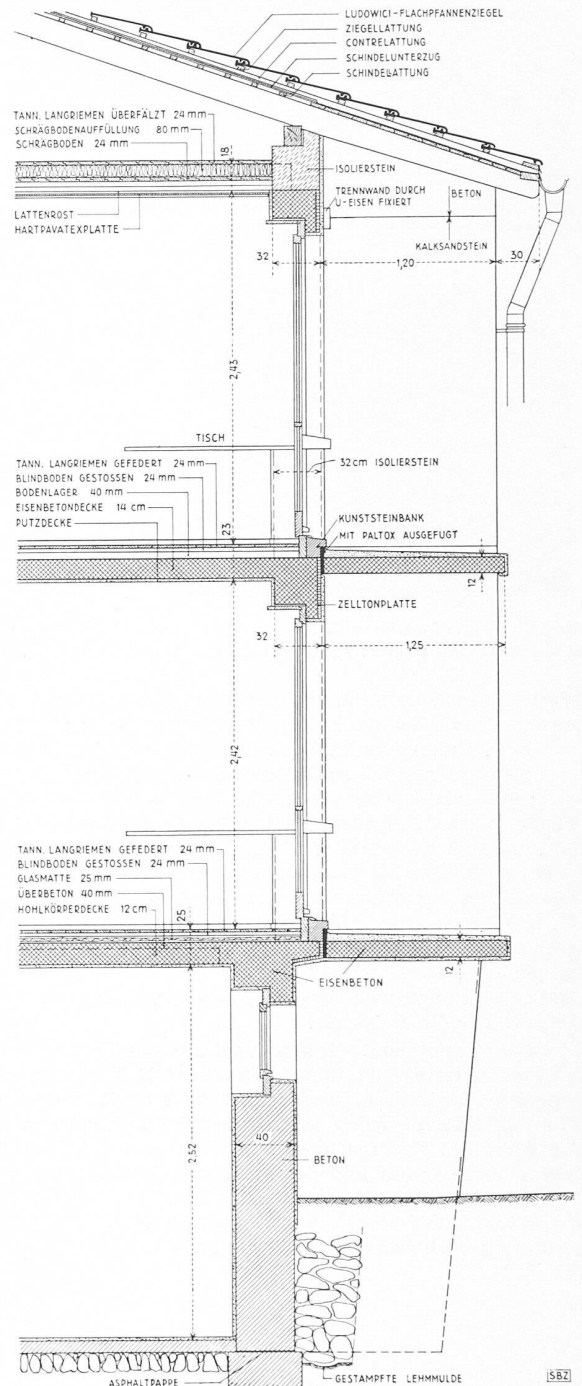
Haupthaus, Fassadeanschnitt des Zimmertrakts, Masstab 1:50
